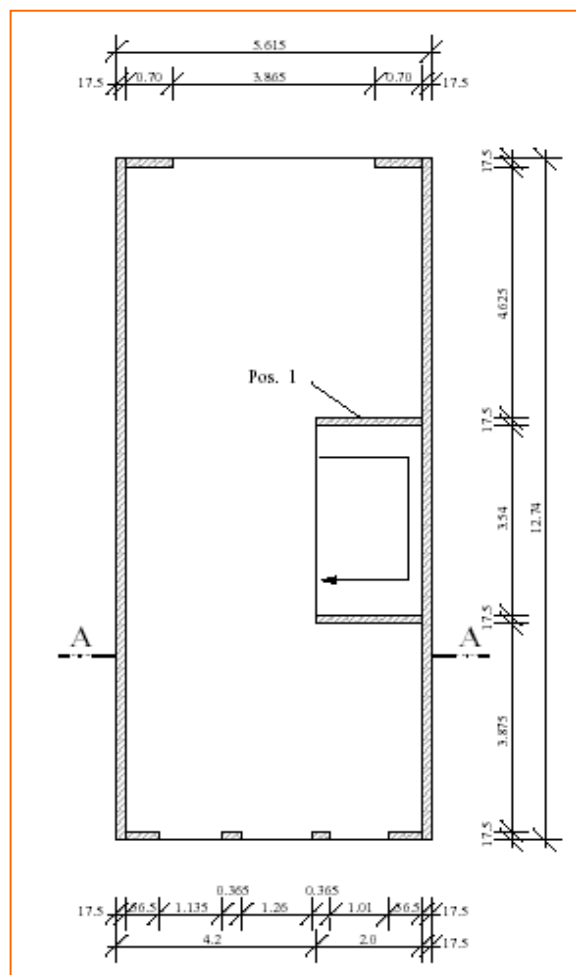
Grundriss des Reihenmittelhauses aus [1]
